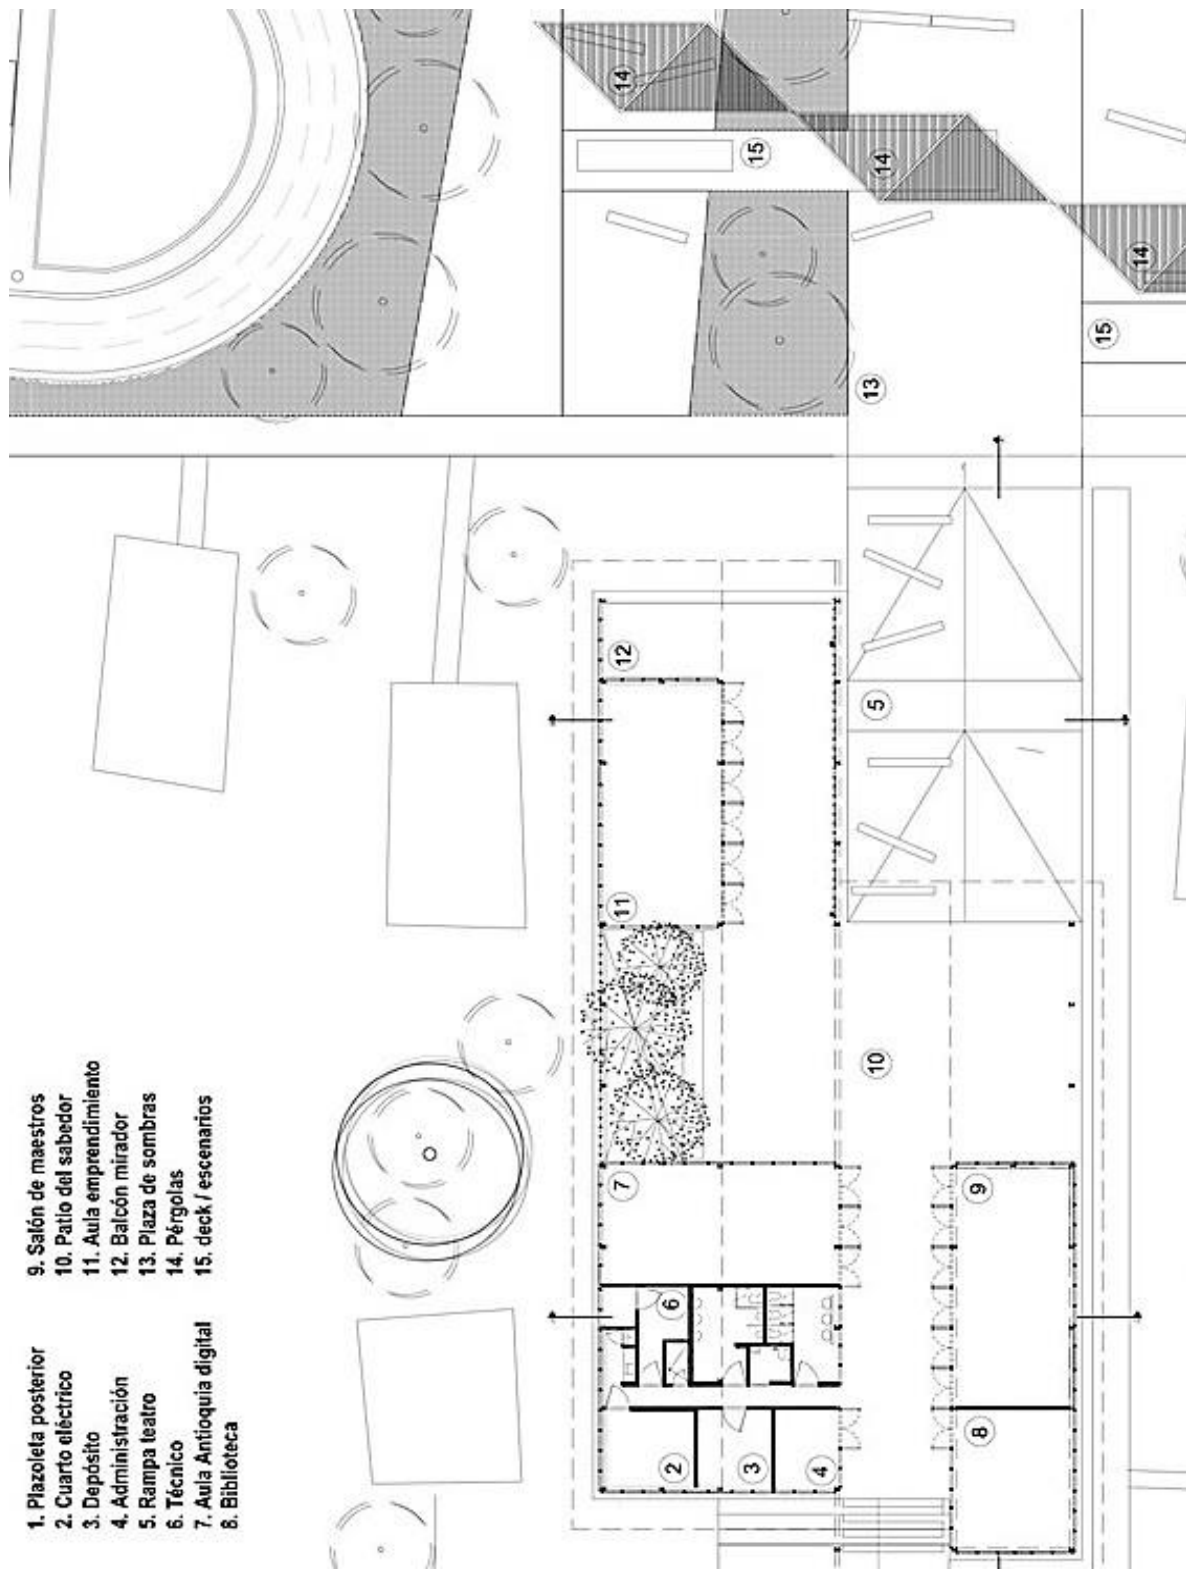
Planta General Vigía del fuerte, adaptado de archdaily.com Recuperado Octubre de 2016
